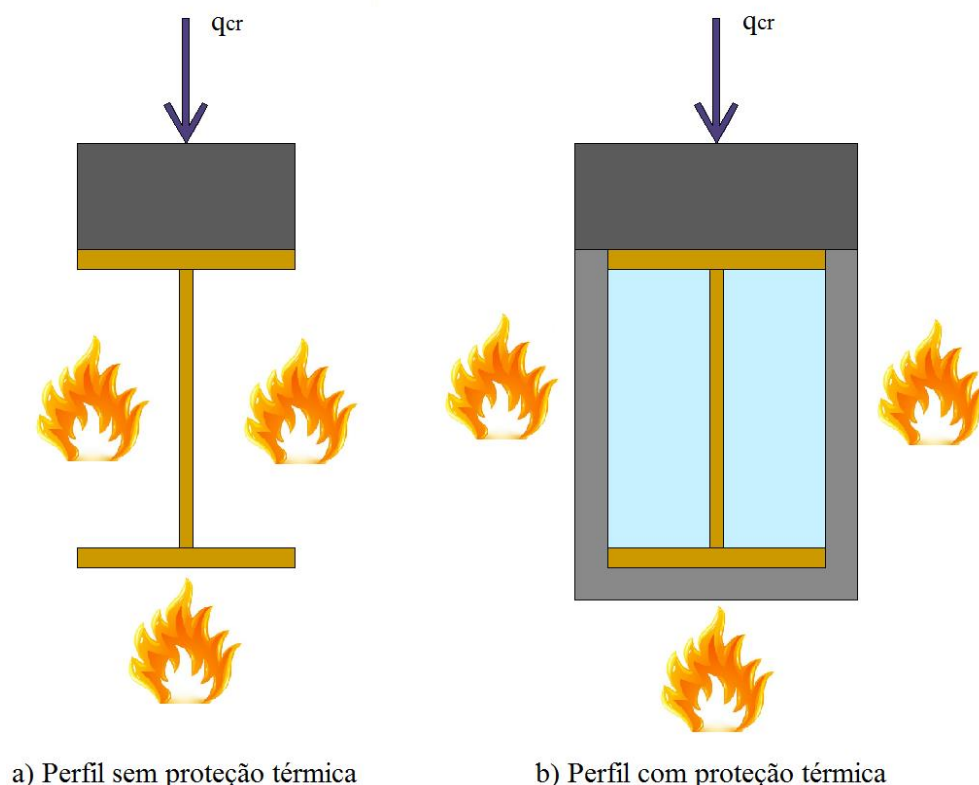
Seção transversal das vigas I em perfil metálico, com carga uniformemente distribuída, submetidas à situação de incêndio.
